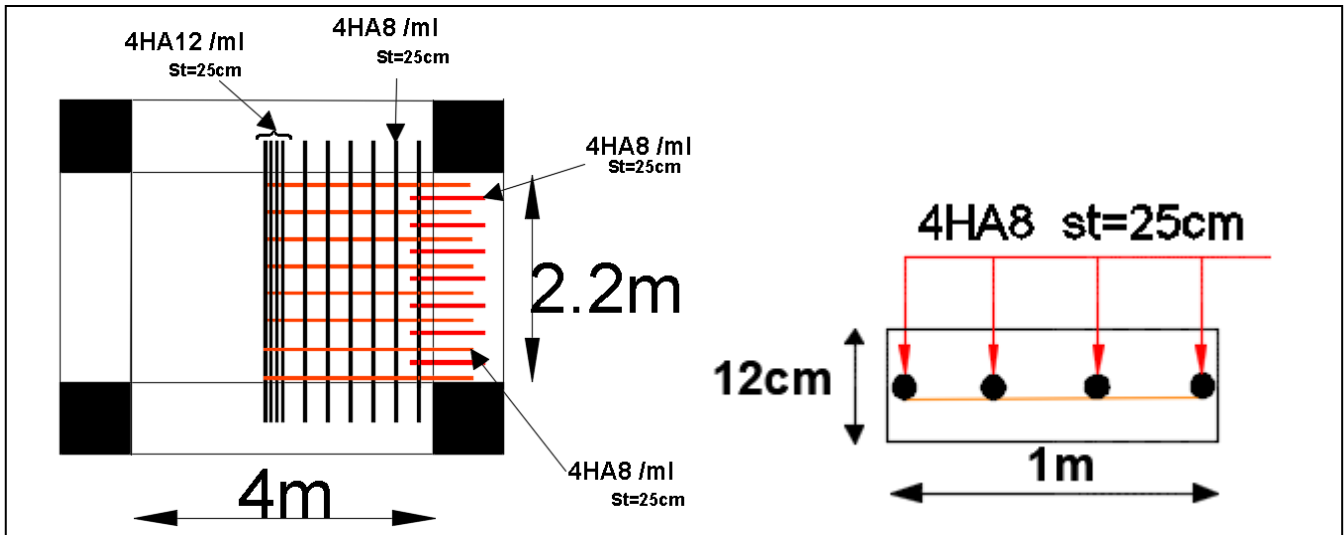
Schéma de ferrailage de la dalle sur 4 appuis.
